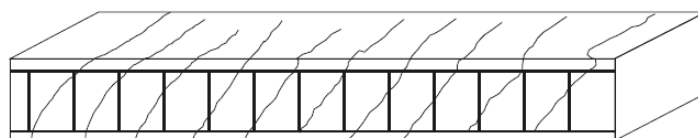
Fissura em elemento de concreto armado causada por esforço de torção
